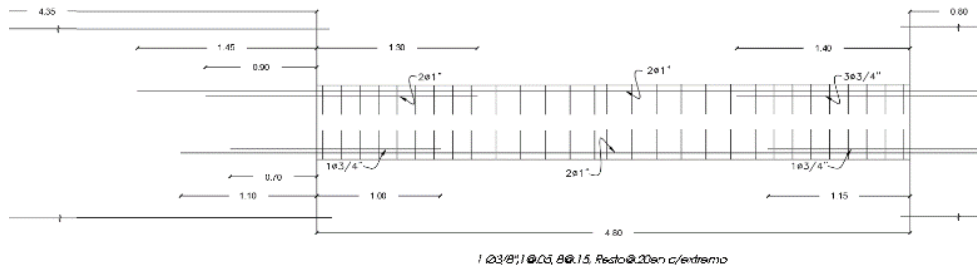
Detalle del refuerzo para la viga VT-07, tramo 3-4
